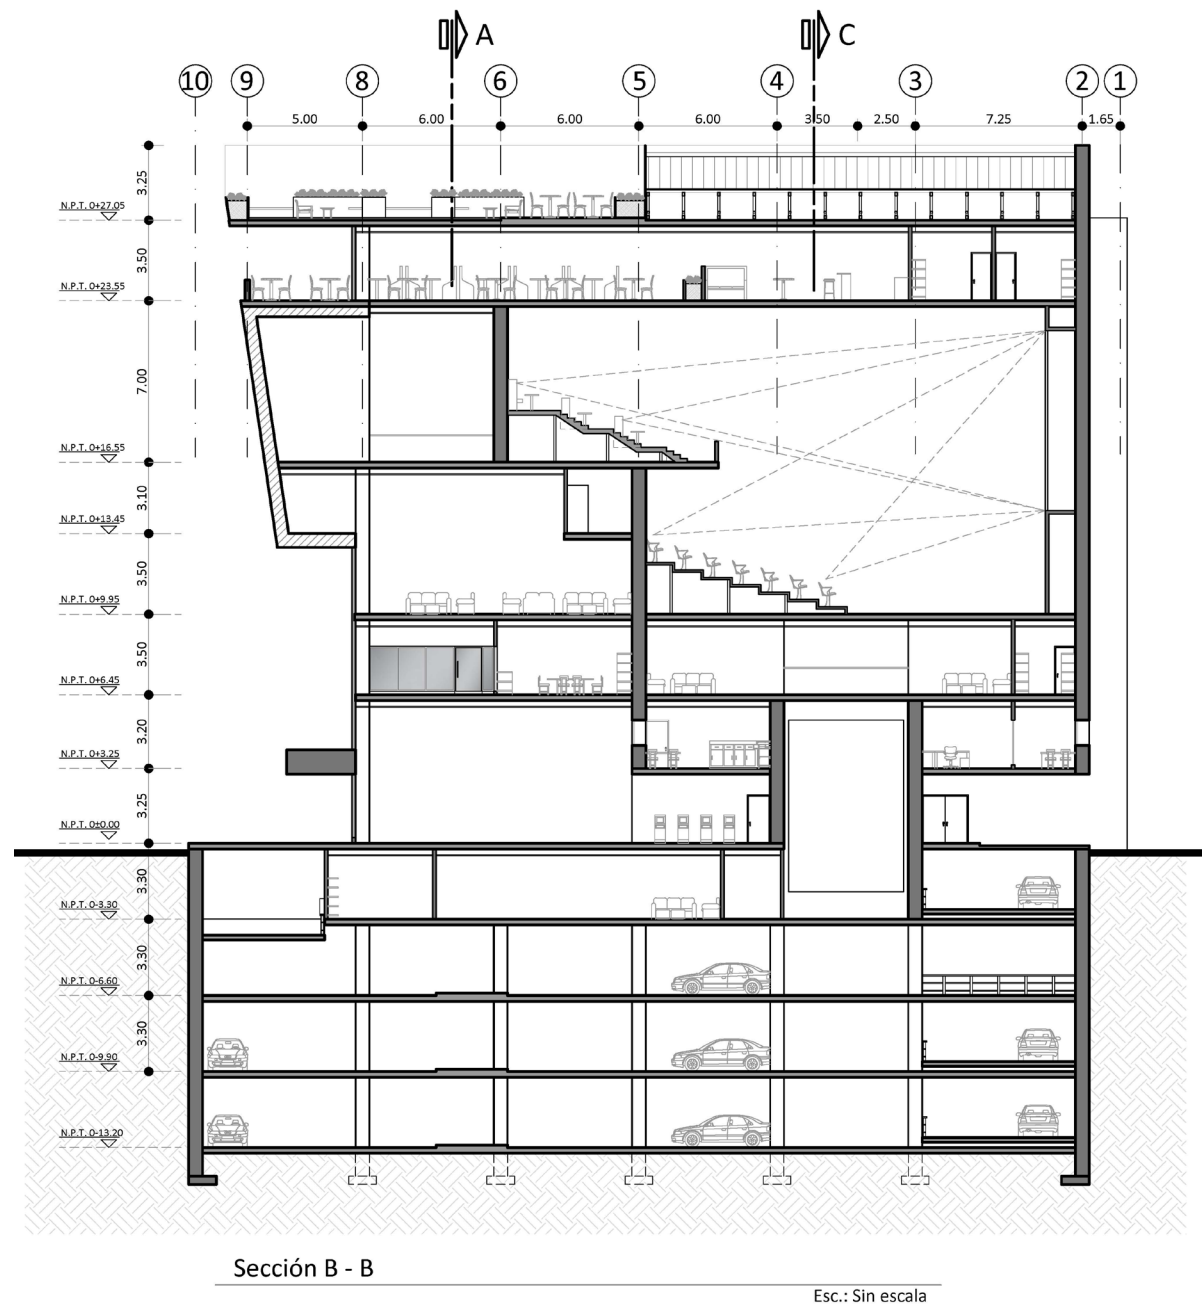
Sección arquitectónica B - B. Fuente: Propia.
